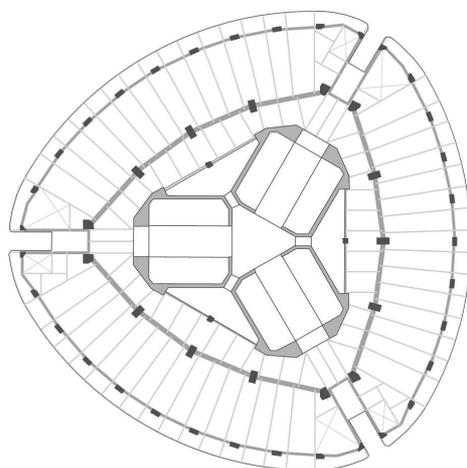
Disposición de la estructura en la planta tipo de la Torre PwC.
